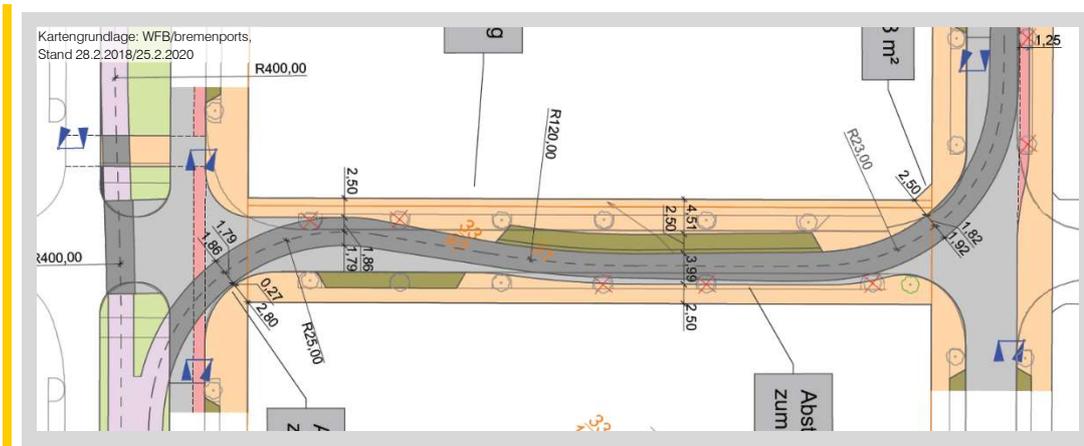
Ausschnitt Lageplan Ehrenfelsstraße
